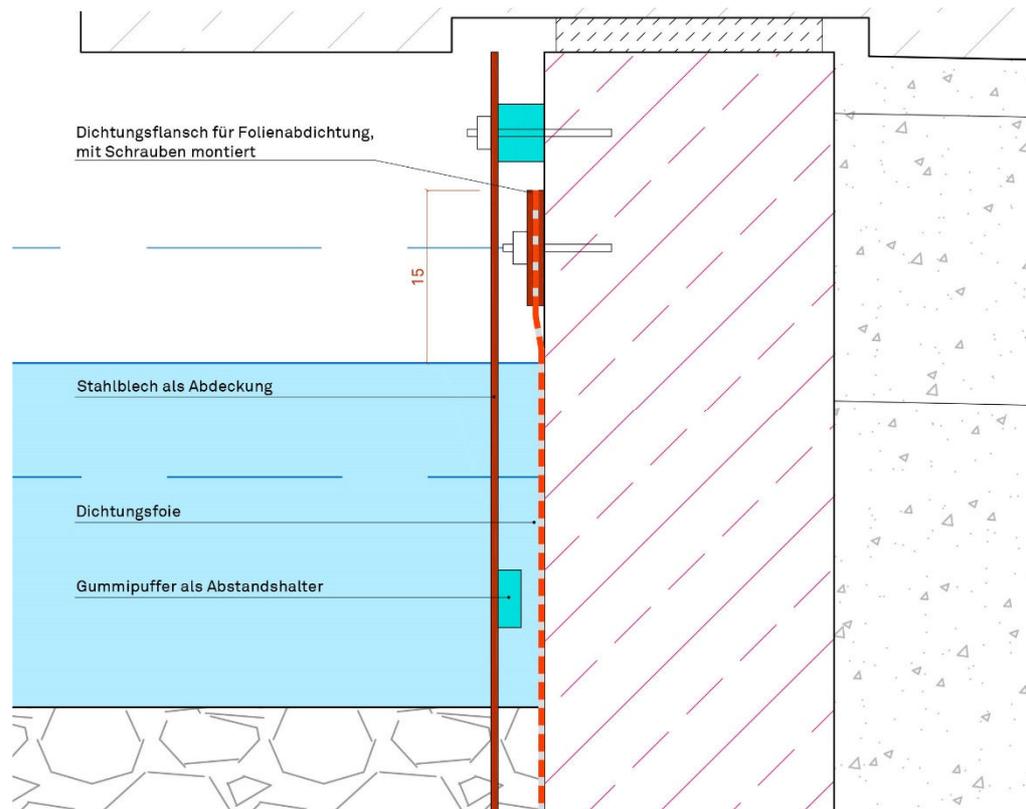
Dichtungsflansch an den Ufermauern mit Stahlabdeckung
